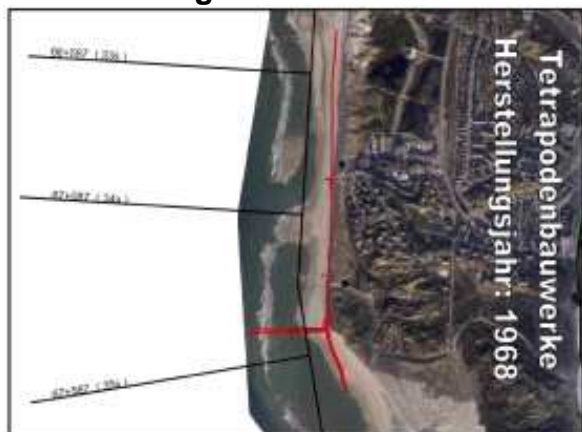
Lageplan Tetrapoden Hörnum LKN-SH
